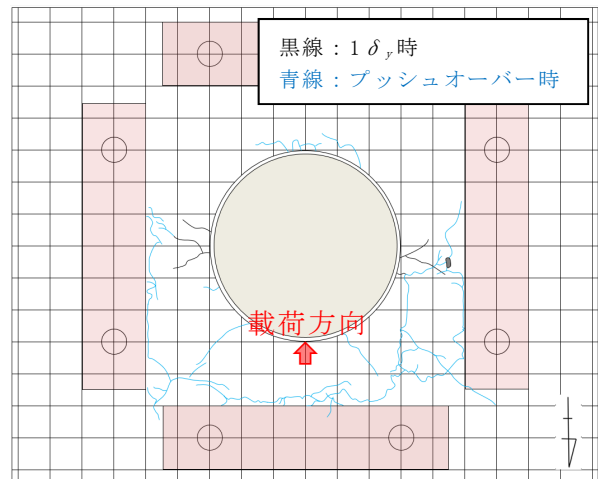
フーチング上面のひび割れ状況図（ケース④）
